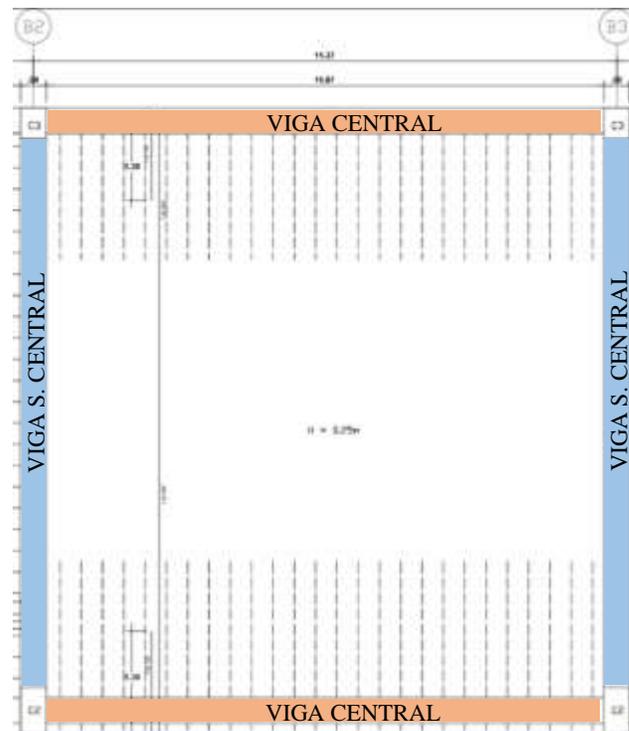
Diseño de losas. Ver plano 62_E03_Plano de losa eje B. Elaboración propia.
